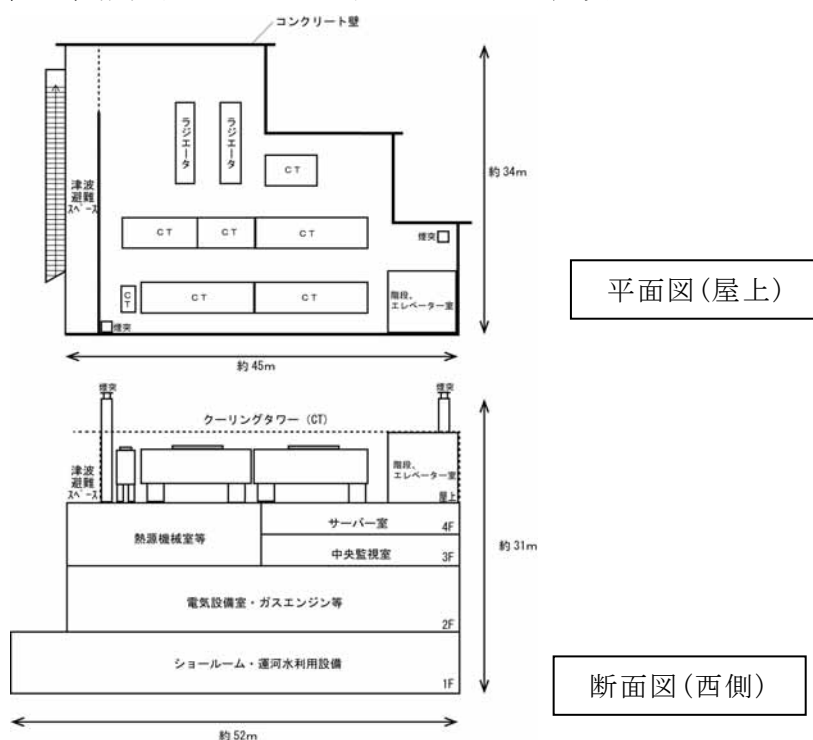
(1) エネルギー施設 A の平面図及び断面図
